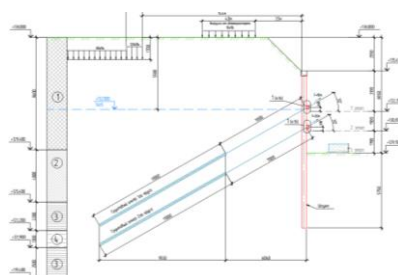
Устройство ограждения котлована с применением грунтовых анкеров.
